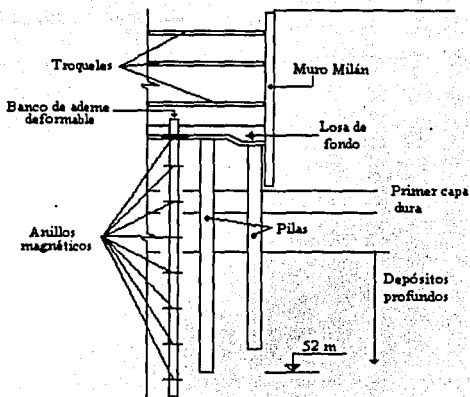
Esquema de instalación del banco profundo de ademe deformable.
